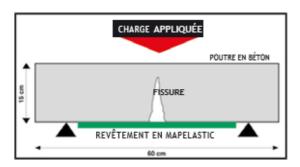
Protection d'une petite fissure avec Mapelastic Zero sur la face inférieure d'une poutre en béton soumise à une flexion
